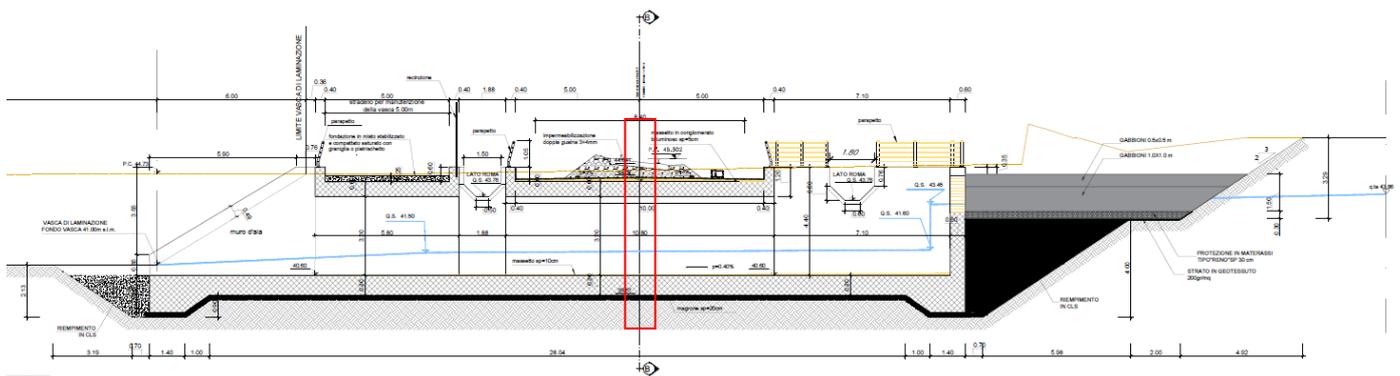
Sezione longitudinale e individuazione delle sezioni SC1 oggetto di verifica.
